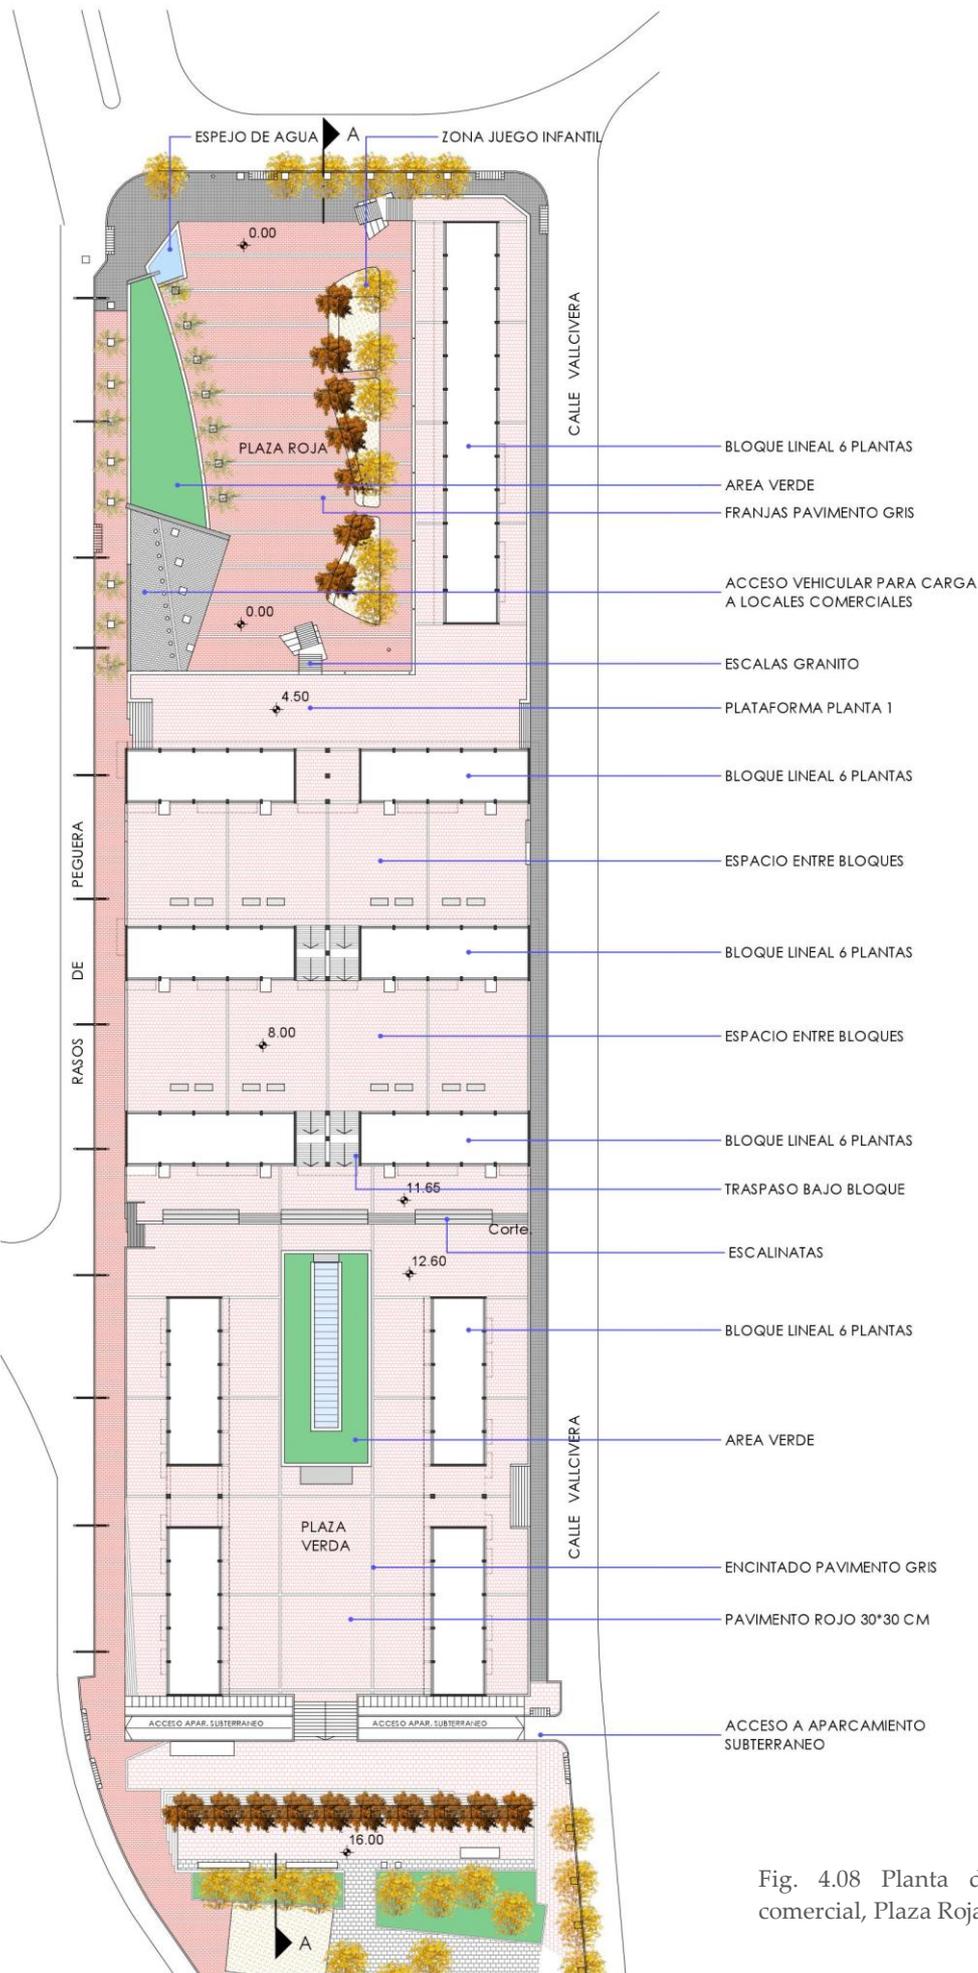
Planta de zona cívica y comercial, Plaza Roja y Plaza Verda.
